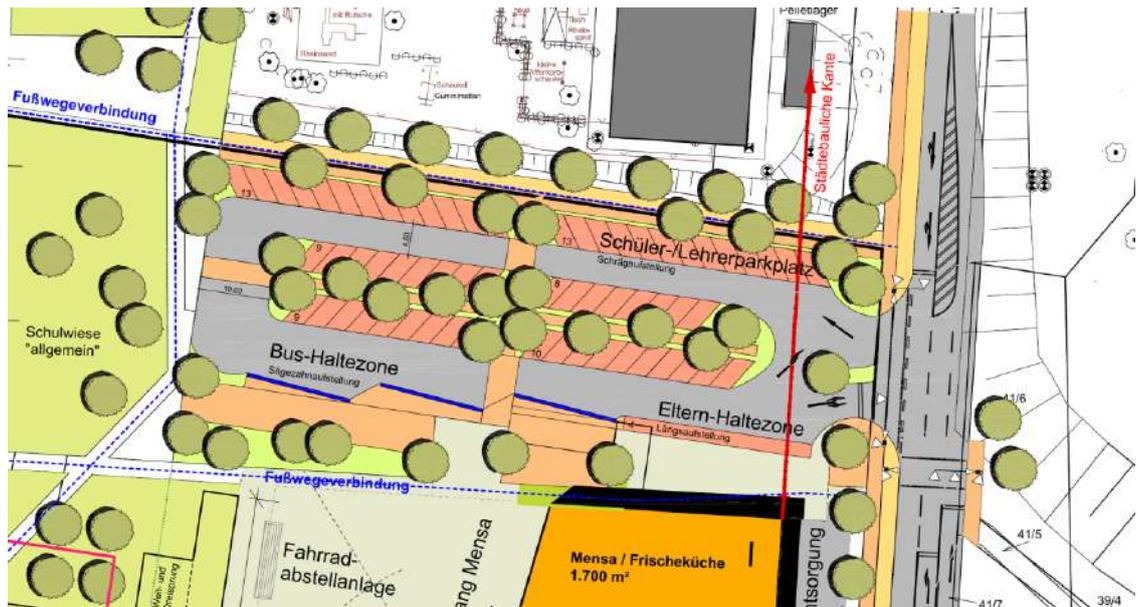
Entwurf Planstraße / Parkplatz „Bildungscampus Füllengarten“
